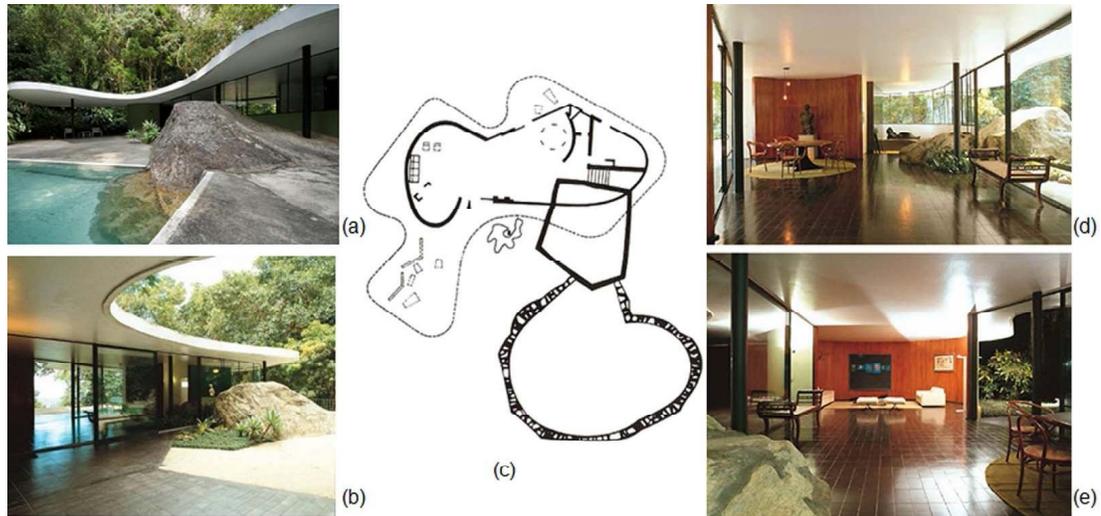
Oscar Niemeyer, Casa Niemeyer, Canoas, Río de Janeiro, Brasil, (1953): (a) y (b) Vistas exteriores, (c) Planta arquitectónica, (d) y (e) Detalles interiores.
